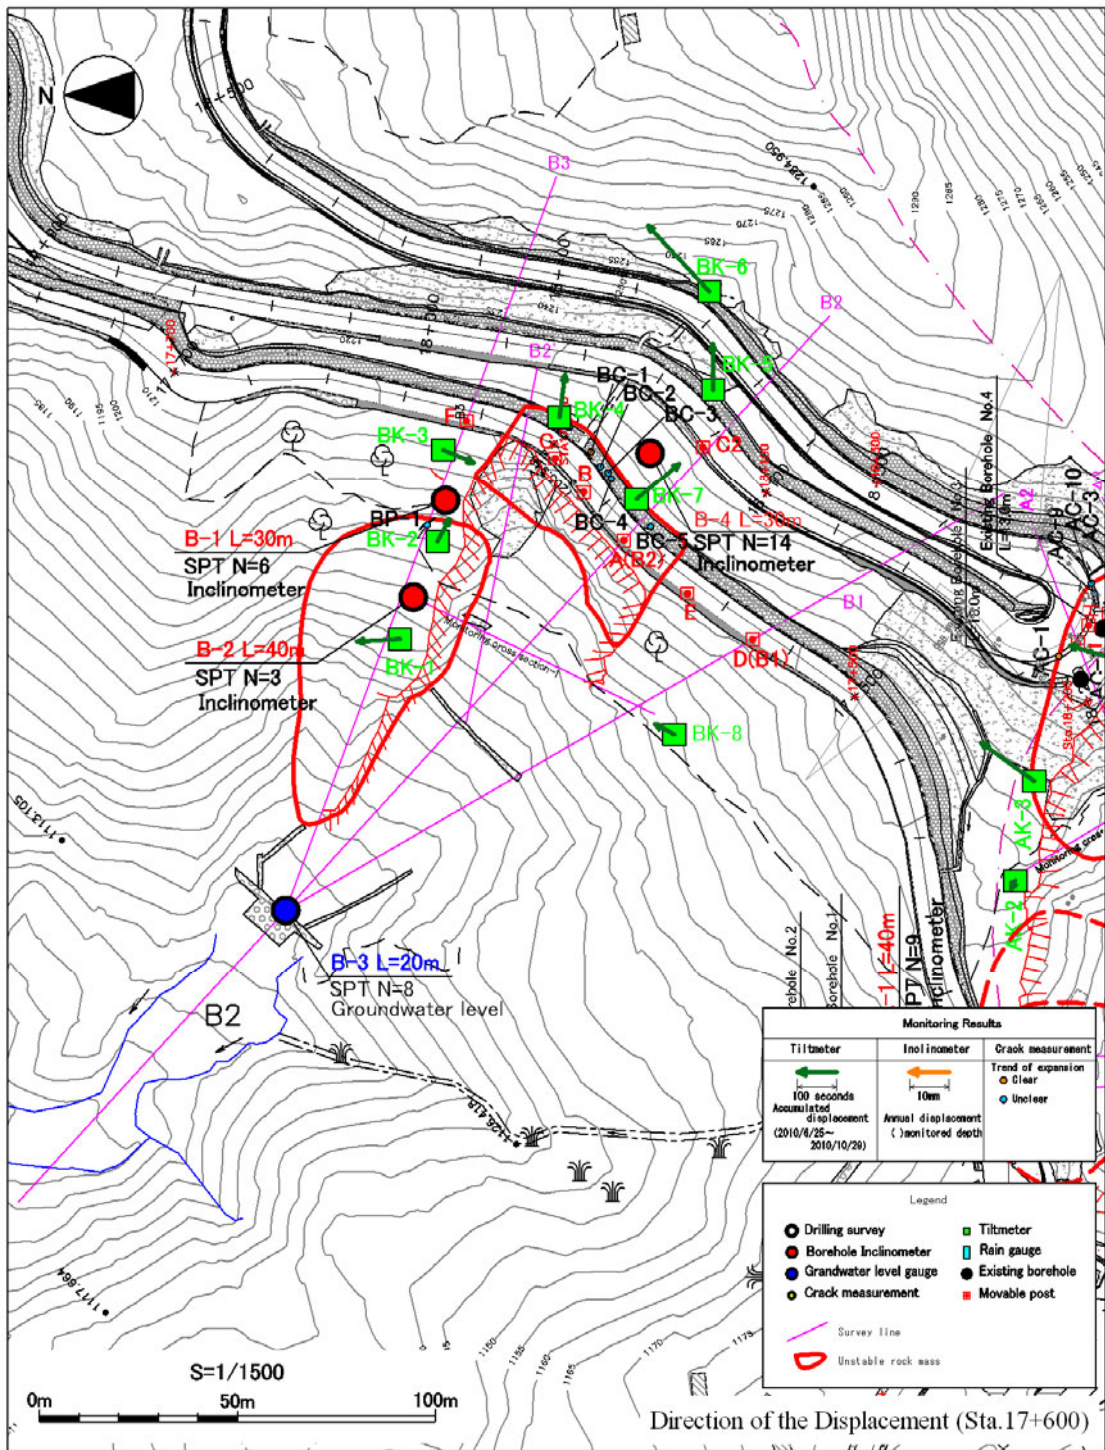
斜変動方向を記入した平面図 (出典：調査団)
